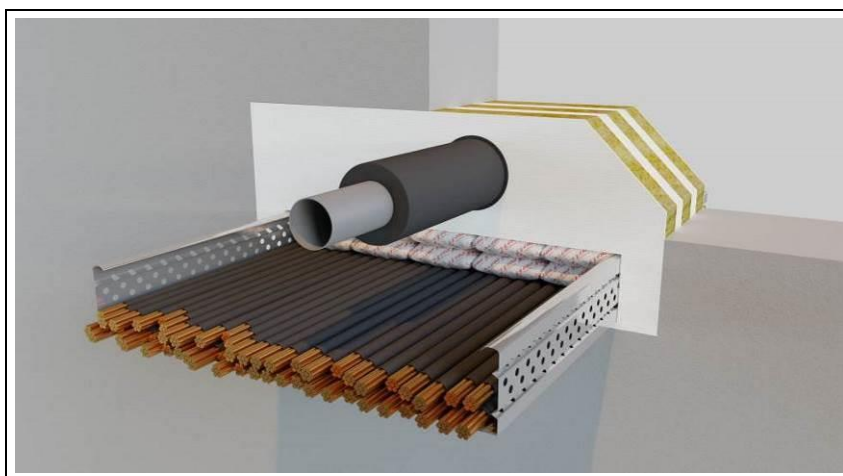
Exemple d'AF PANEL dans une mur rigide EI 240.
